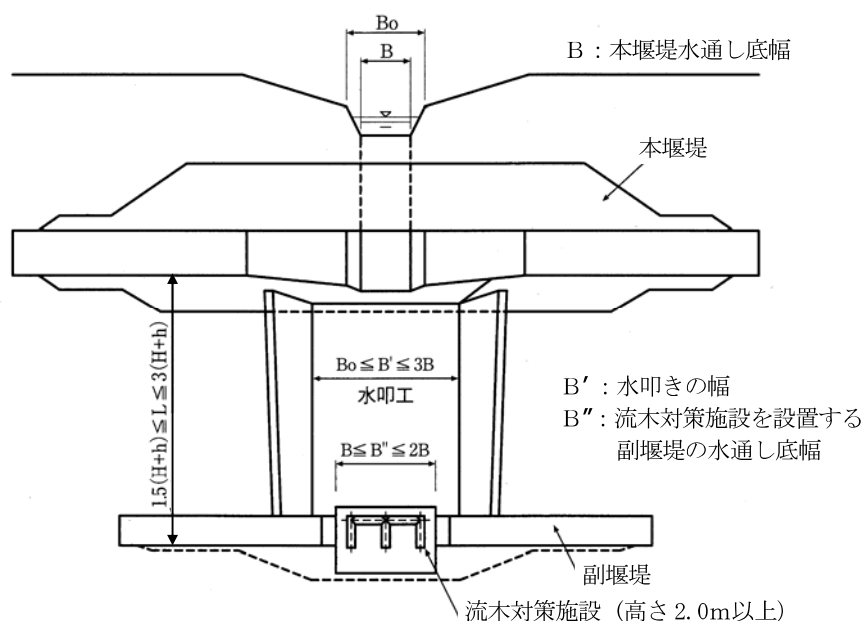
副堰堤に流木対策施設を設置する場合の前庭保護工の寸法
